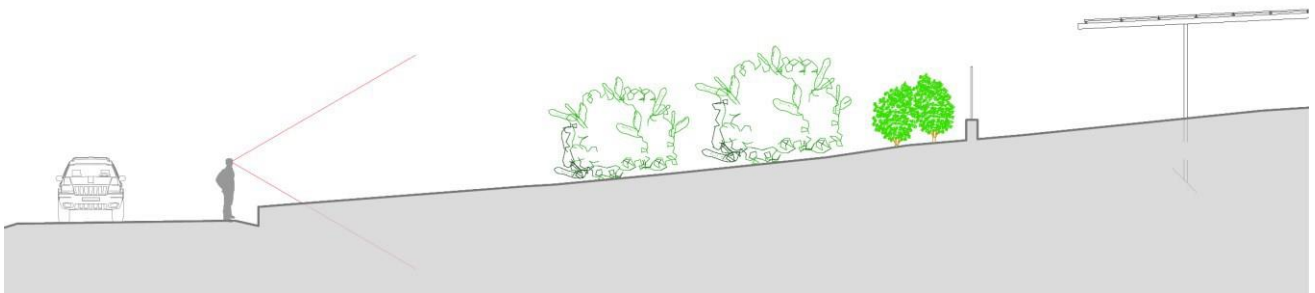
Sezione stradale -Mitigazione ambientale perimetrale.
